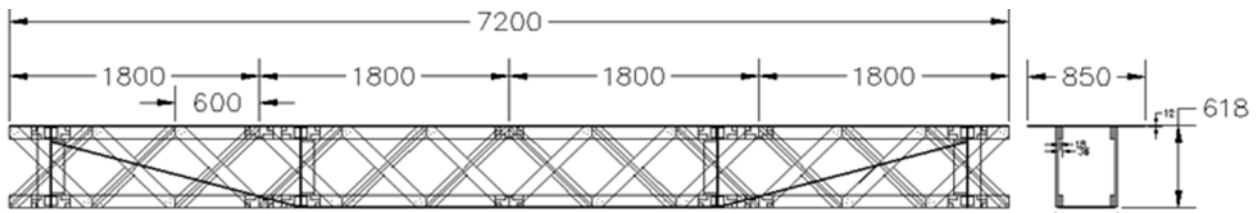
クロスウェブ橋側面図と断面図(単位 : mm)
